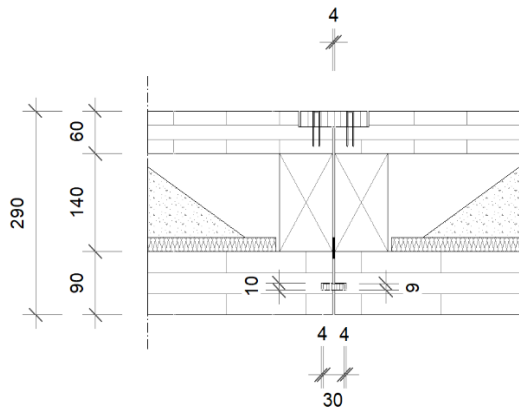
Detaildarstellung PUR Dichtungsband im Bereich Wandanschlussbereich
